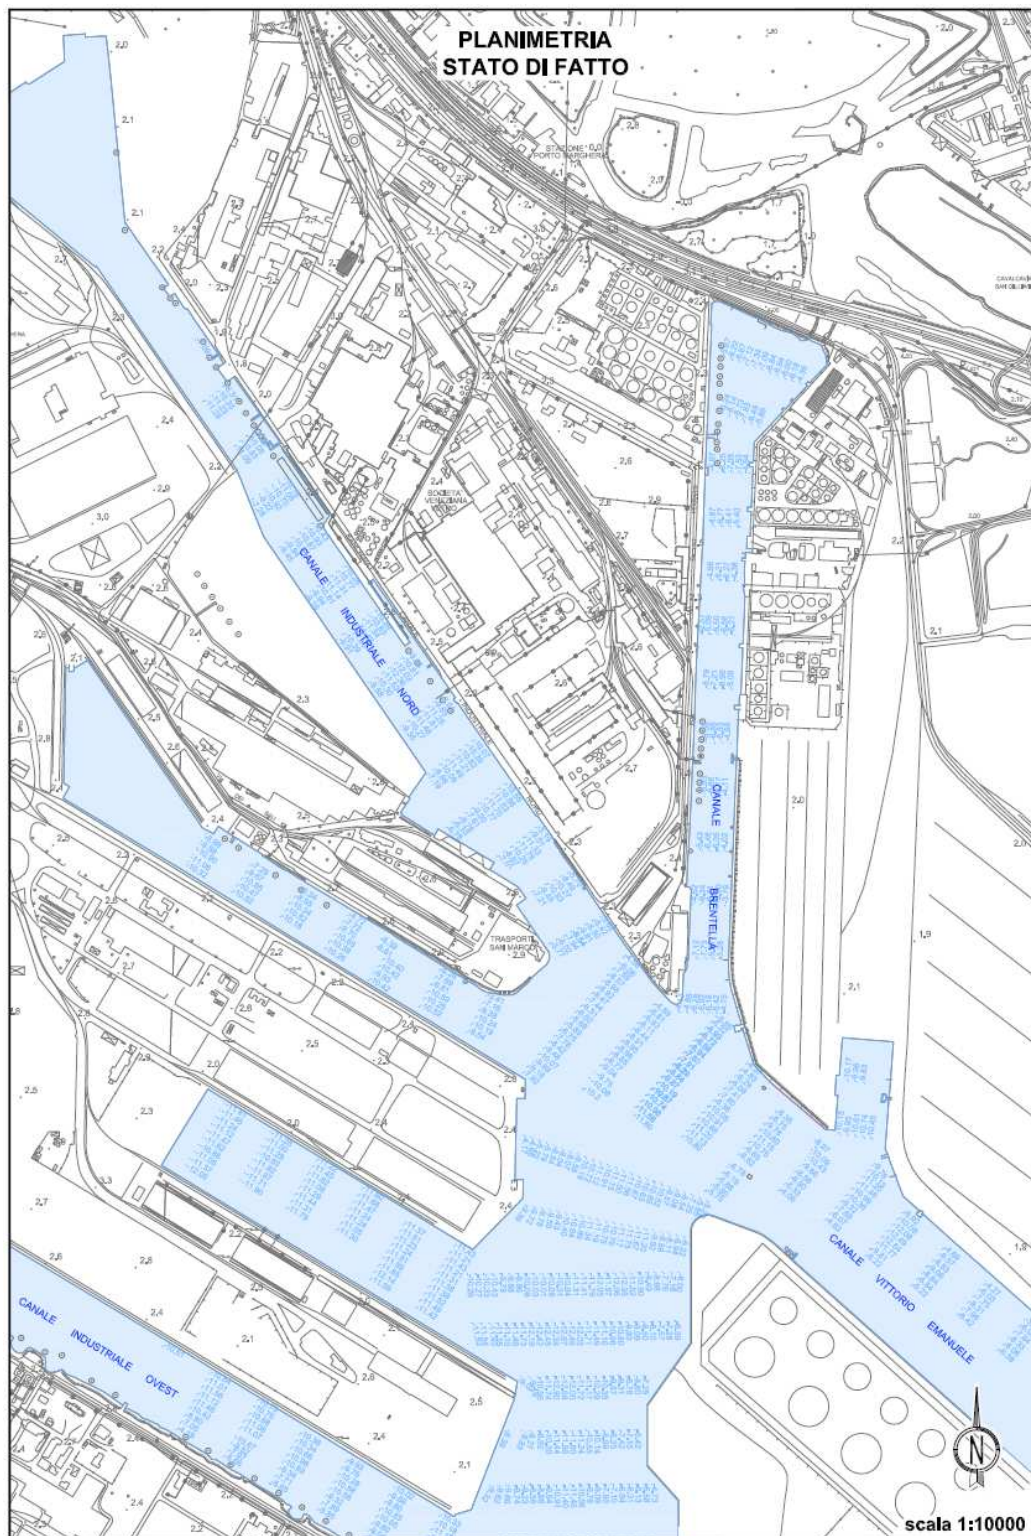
PLANIMETRIA DELLO STATO DI FATTO.
